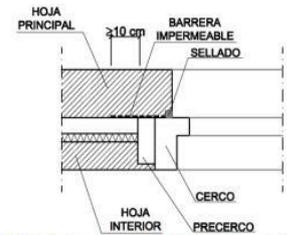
Ejemplo de encuentro de la fachada con la carpintería
